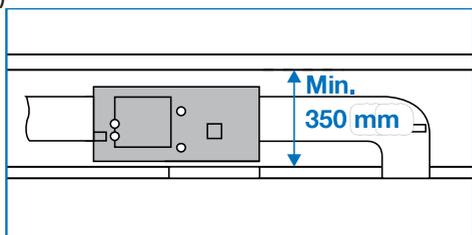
Espaçamento típico entre forro e laje para instalação de unidade internas do tipo cassette
